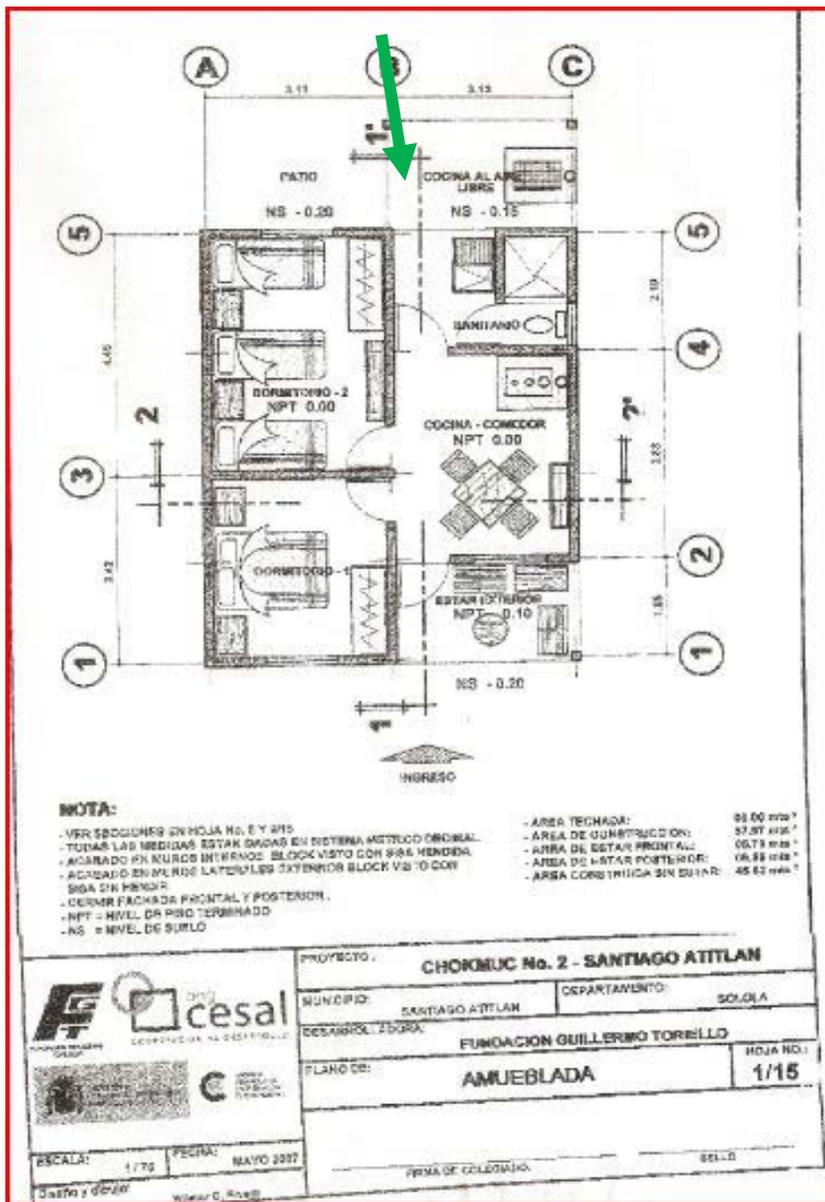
PLANTA AMUEBLADA, PROPUESTA HABITACIONA CHUKUMUK
